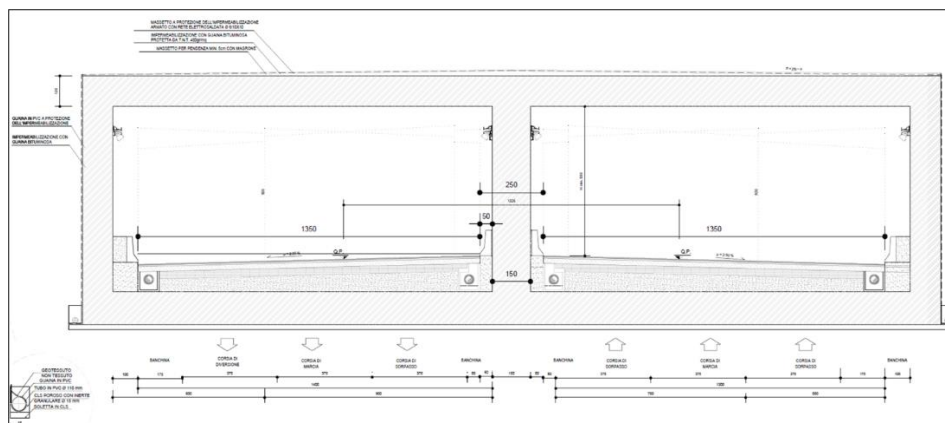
Sezione tipo longitudinale galleria artificiale attraversamento S.S. 1bis
